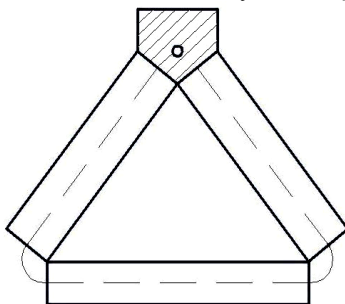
Схема бетонирования монолитных участков балки для последующего монтажа
